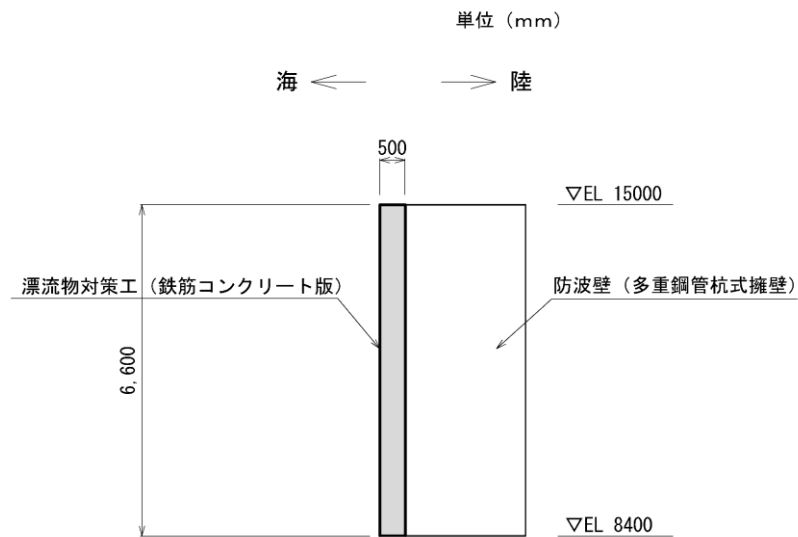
(3) 漂流物対策工(鉄筋コンクリート版)の構造概要図(断面図)
